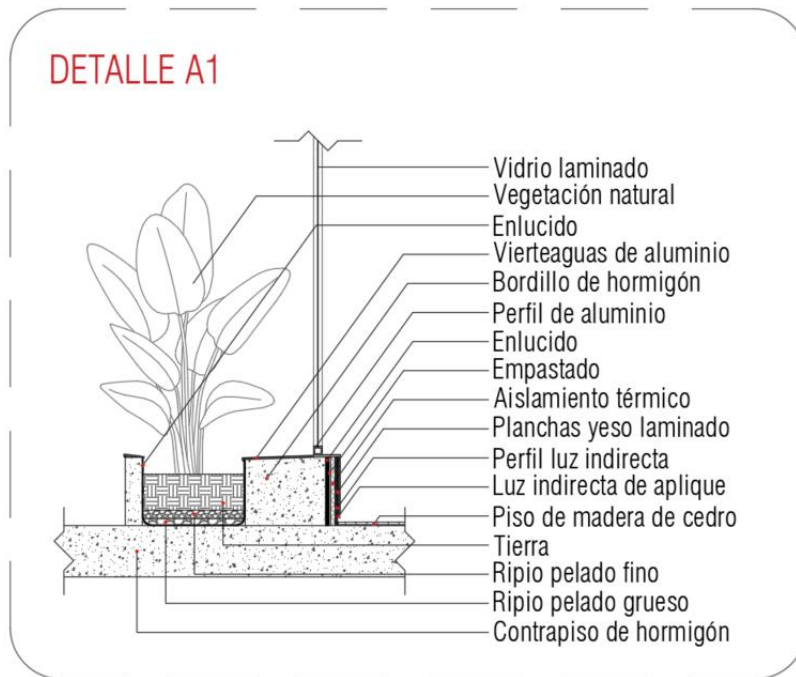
Detalle A1 - Proyecto definitivo. Elaboración propia.
